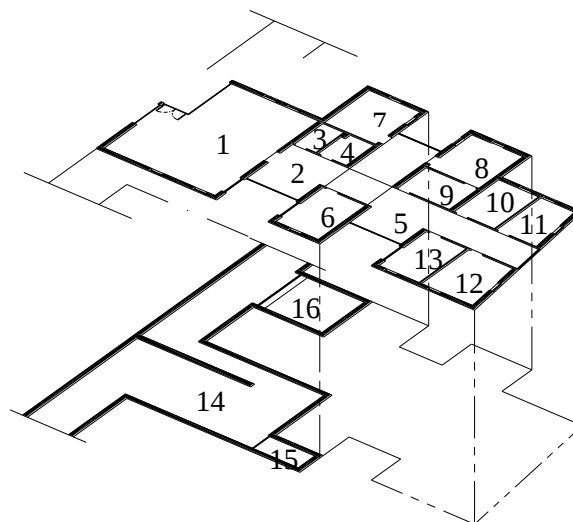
| Planta esquemática do Piso Térreo e Piso -1, Consultas Externas, Edifício 4.
